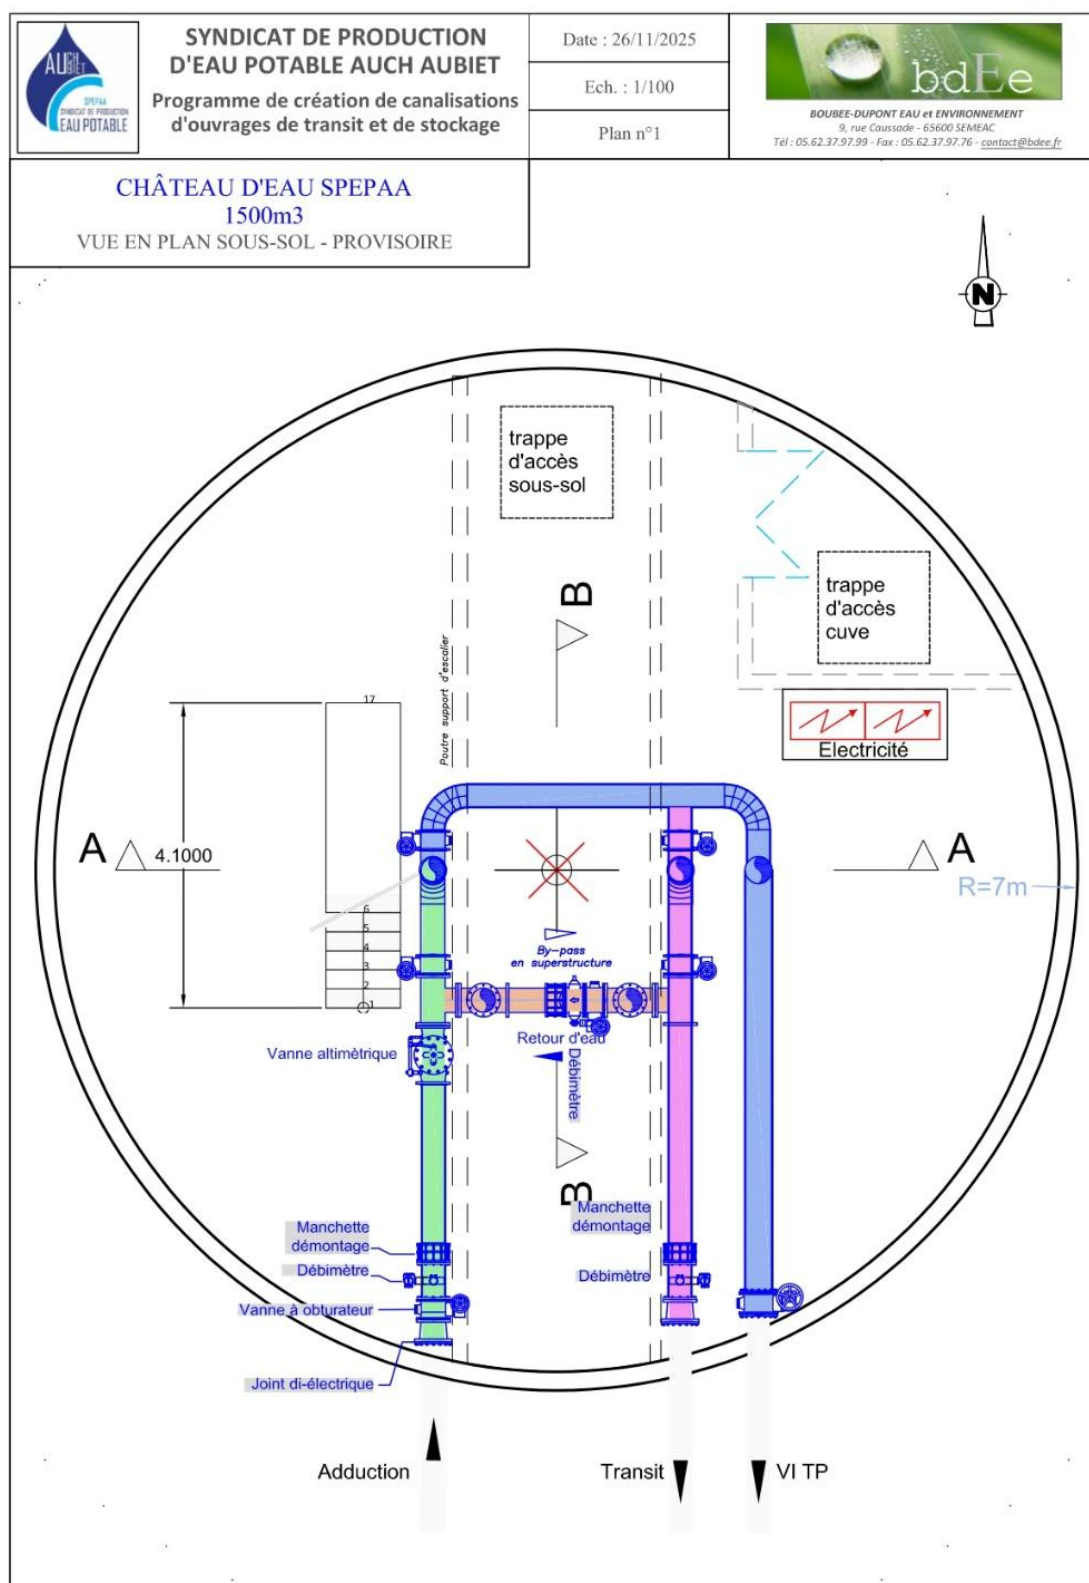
Coupe Vue en plan © BOUBÉE DUPONT EAU & ENVIRONNEMENT
